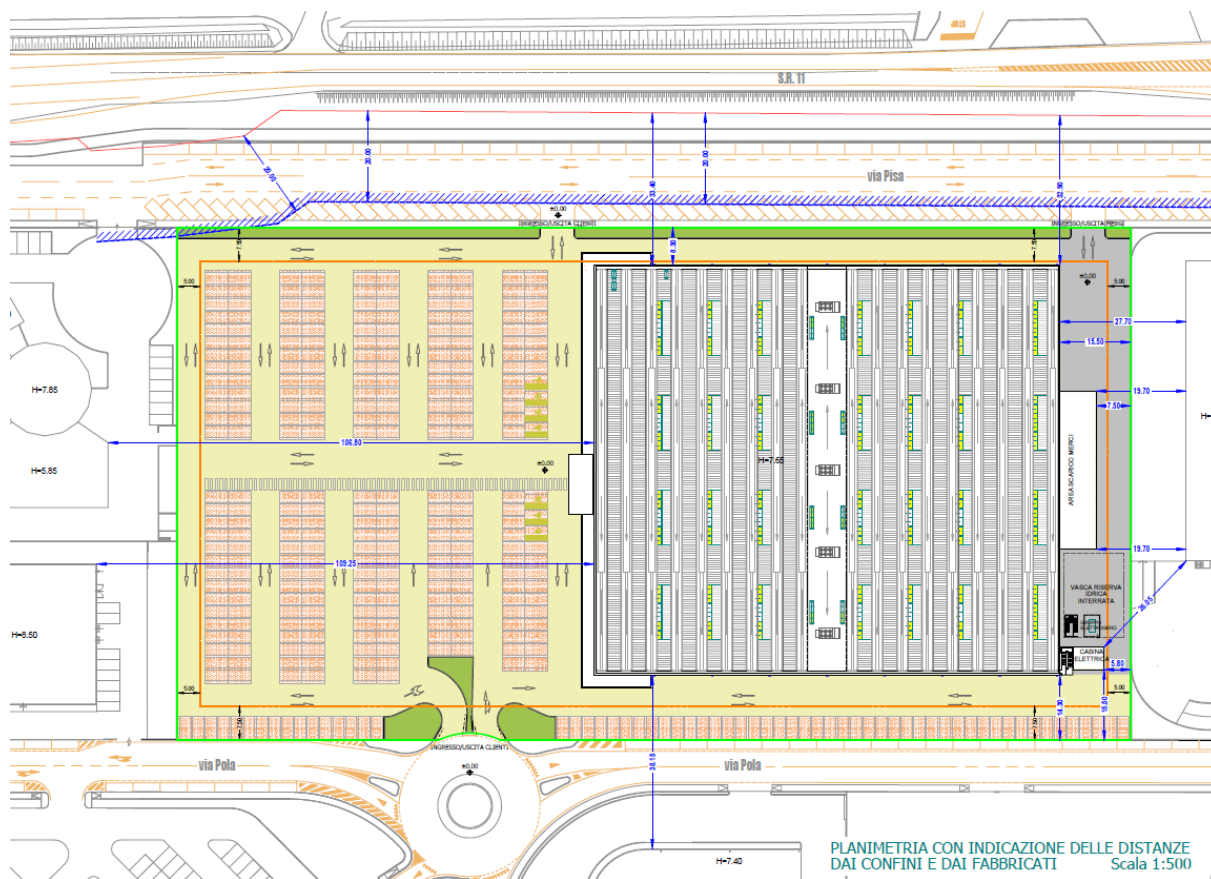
Planimetria Edificio “A” (Tavola A-01)
